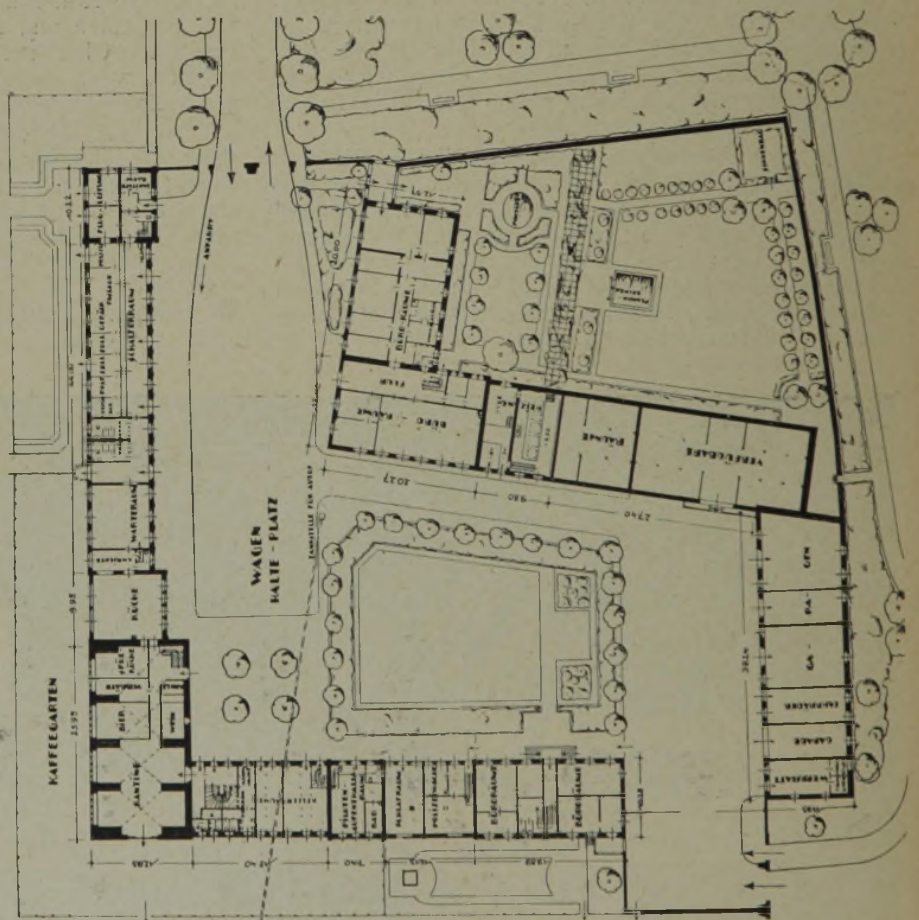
u. 4. Grundrisse der Betriebsgebäude des Flughafens.
